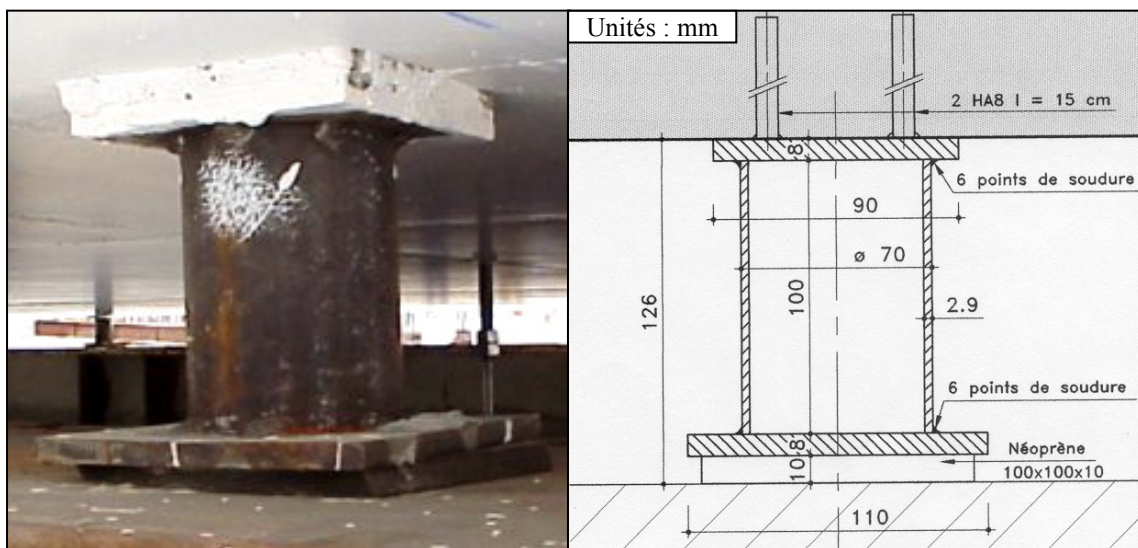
photographie et coupe verticale d'un appui fusible de la dalle d'essai horizontale
